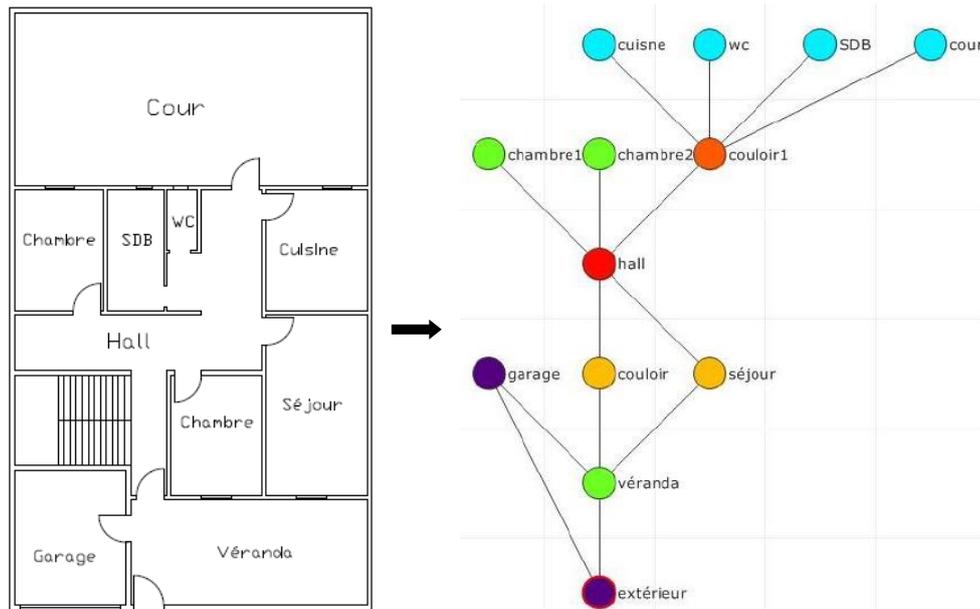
un exemple d'un plan d'une maison, traduit en graphe justifié.
